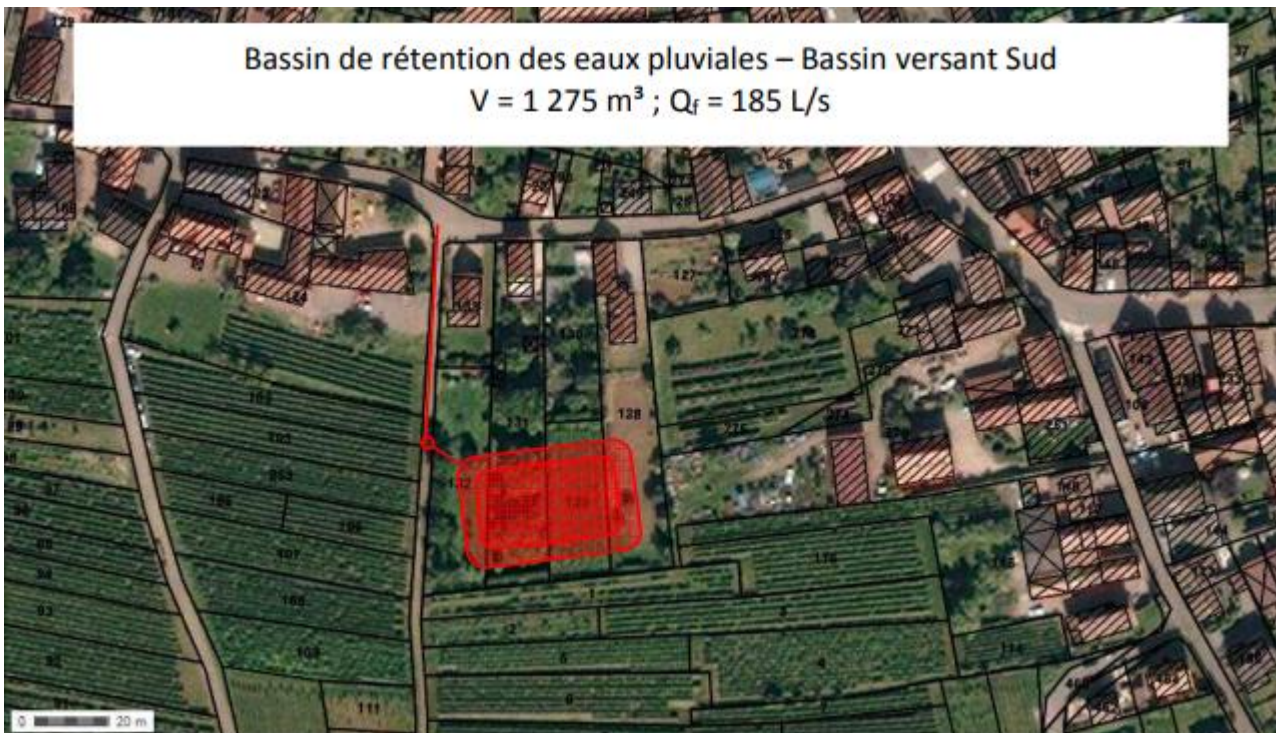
Bassin de rétention des eaux pluviales - Bassin Versant Sud - IRH Ingénieur conseil
